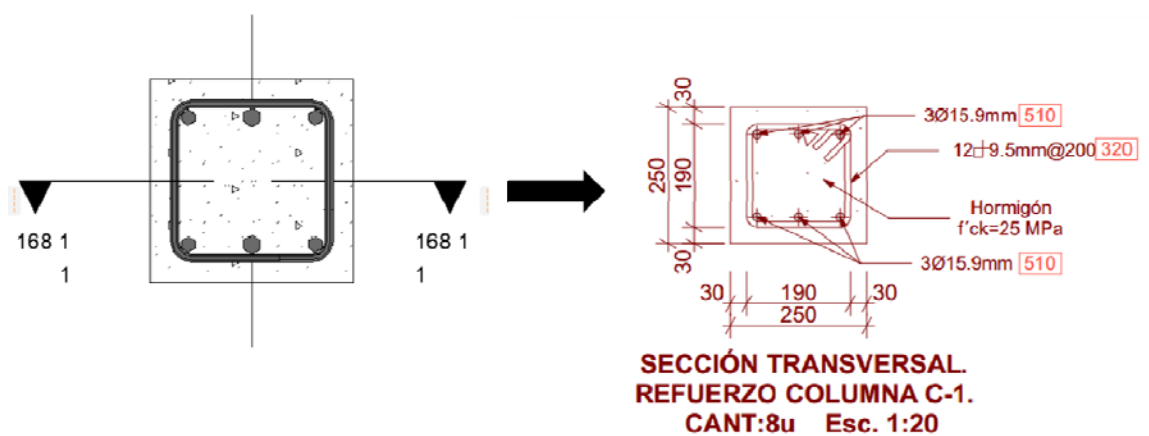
Vista de corte 1:1 y Sección transversal de la columna C-1 utilizando la información paramétrica del modelo
